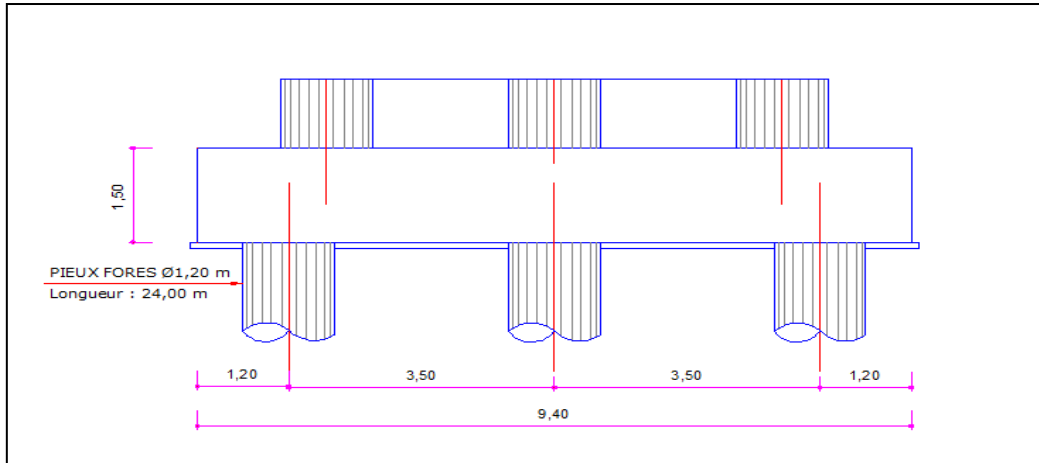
Schéma semelle sous pile sens longitudinal.
